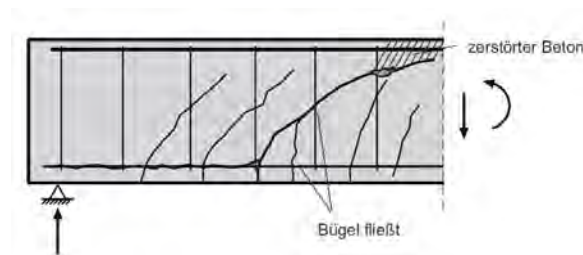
Biegeschubversagen mit Schubbewehrung [31]
